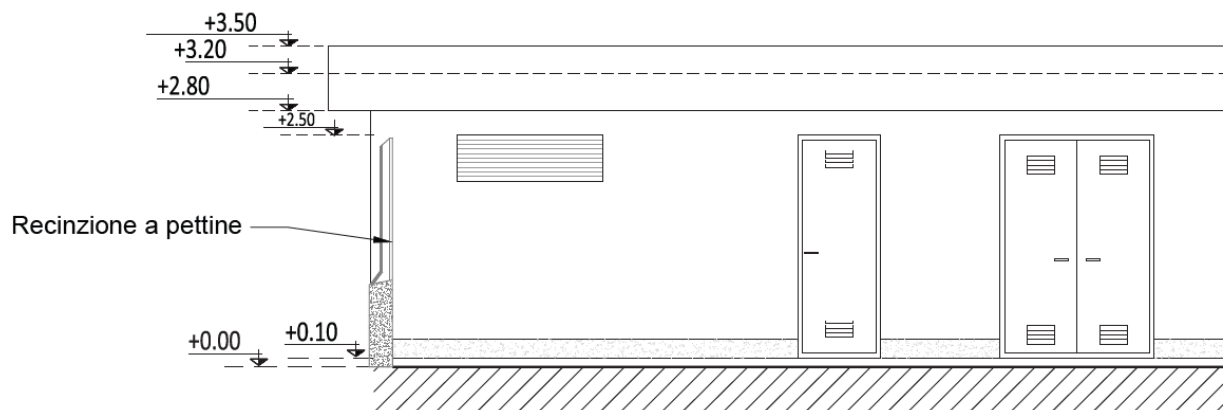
Edificio di sottostazione, stralcio Doc. (016708DADM34625" (Pianta e prospetti dell'edificio di sottostazione)
